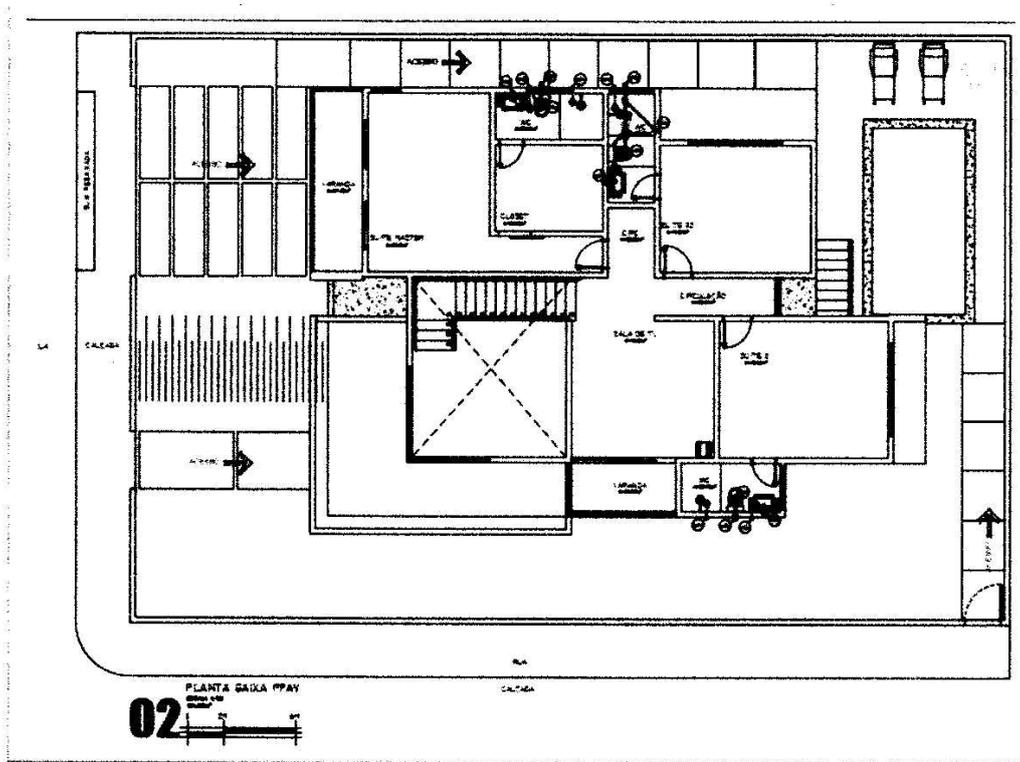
Planta baixa 1º Pav. Instalação predial de tubulação de esgoto.
